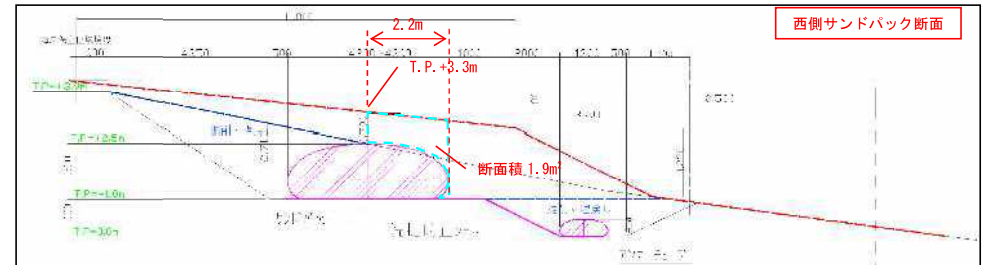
サンドバック設置箇所の標準断面図と断面変化の状況
